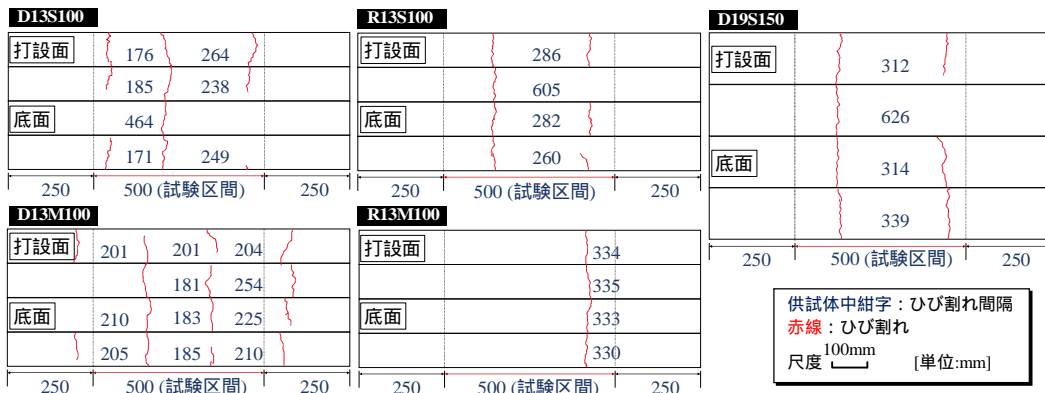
供試体表面のひび割れ発生状況（荷重試験終了時点）
